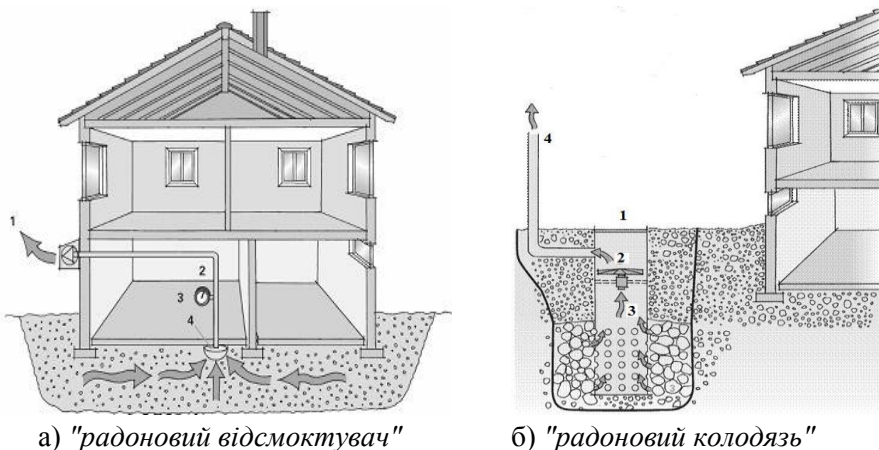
Схеми систем для відведення радону з-під фундаменту будинку [17]
